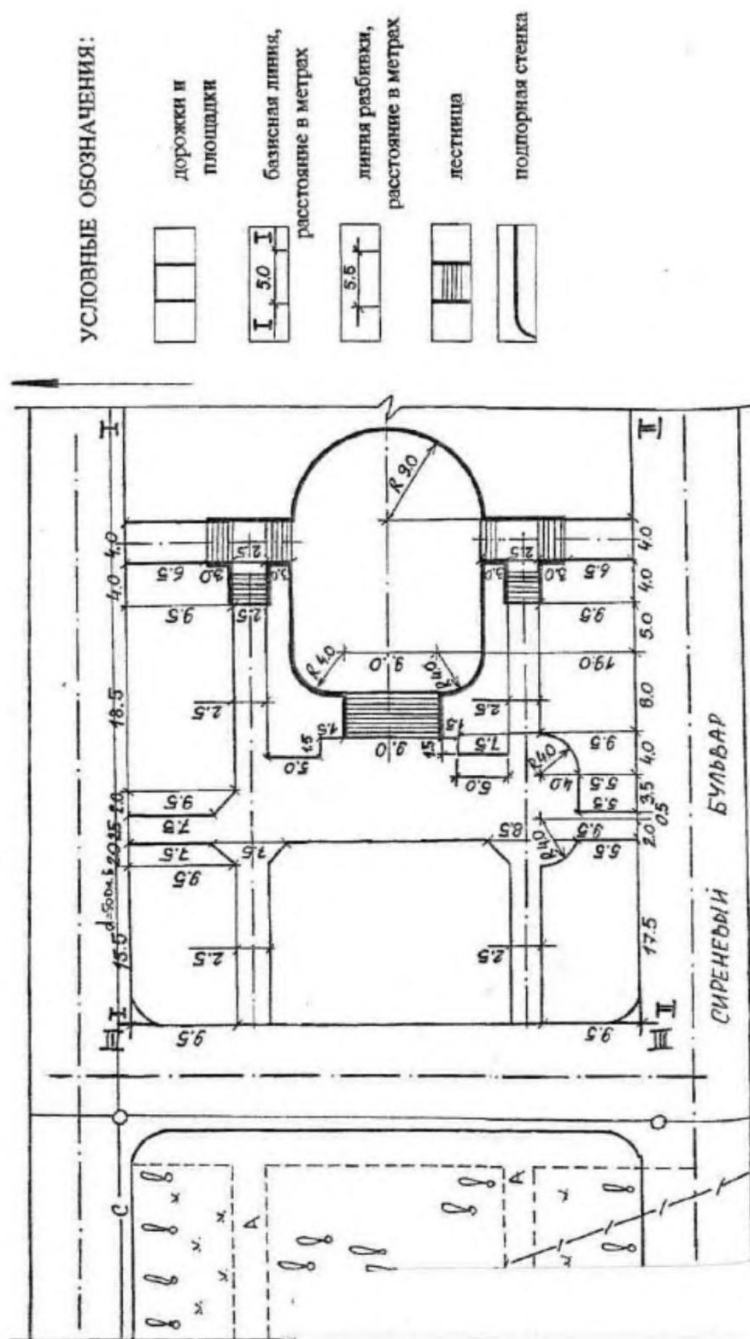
Пример чертежа плана благоустройства территории сквера (разбивочный чертеж планировки)
